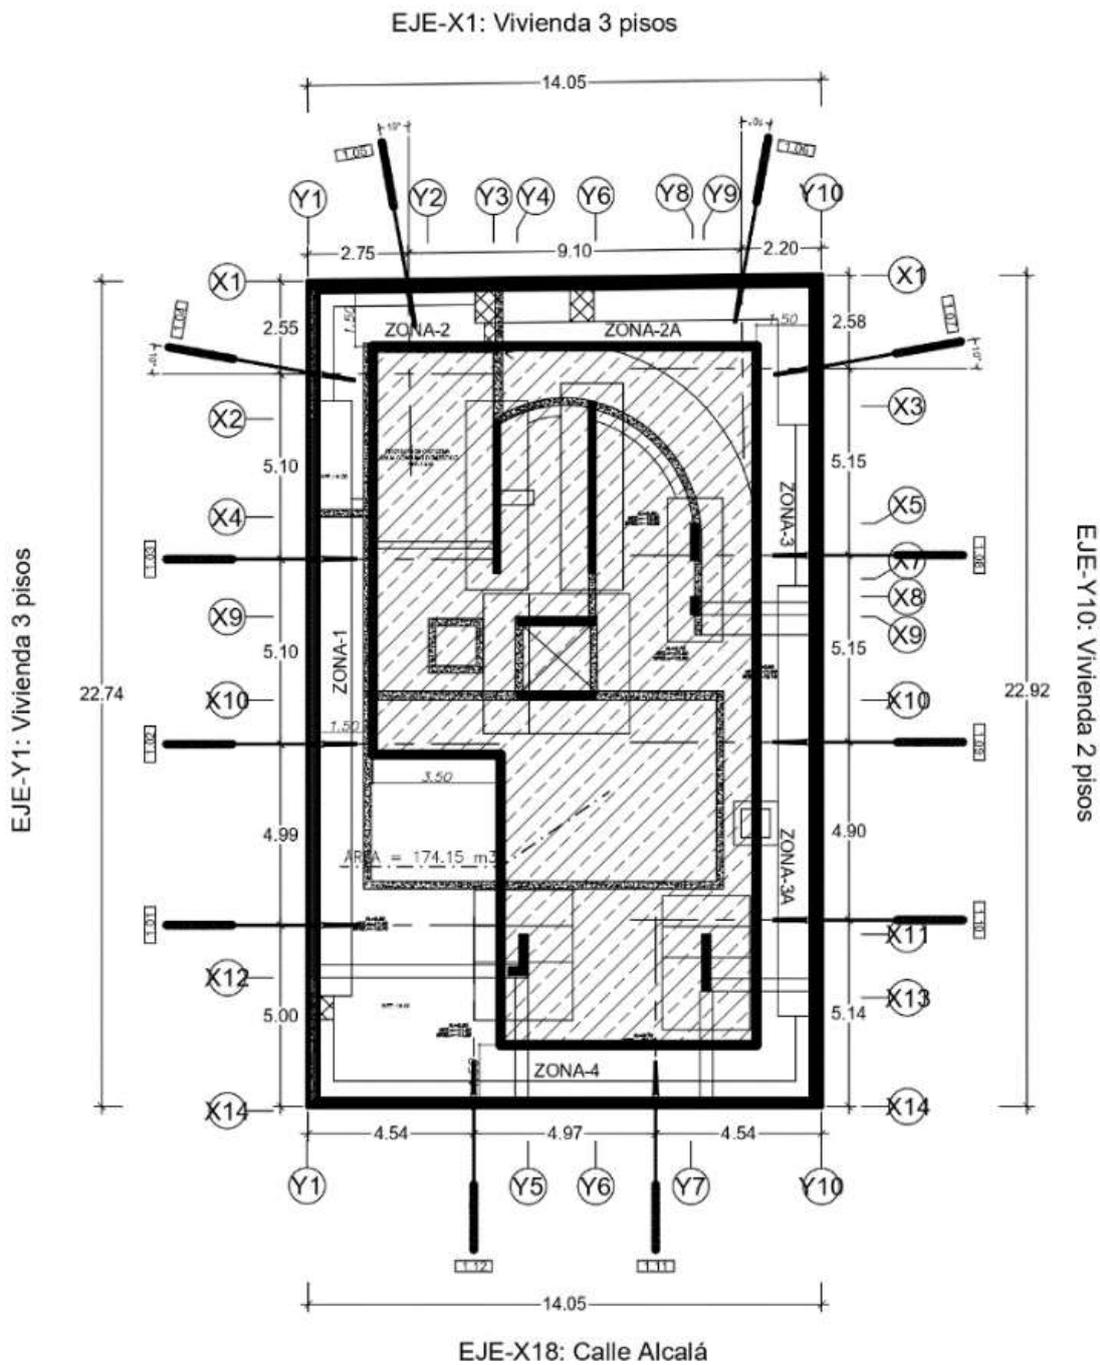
Plano de muro pantalla del primer anillo incluyendo el área de la excavación masiva.
